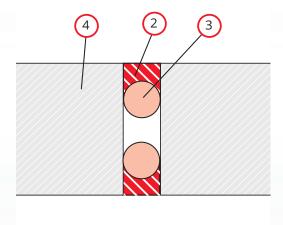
Schnitt Deckenfuge Fugenbreite ≤ 40 mm
